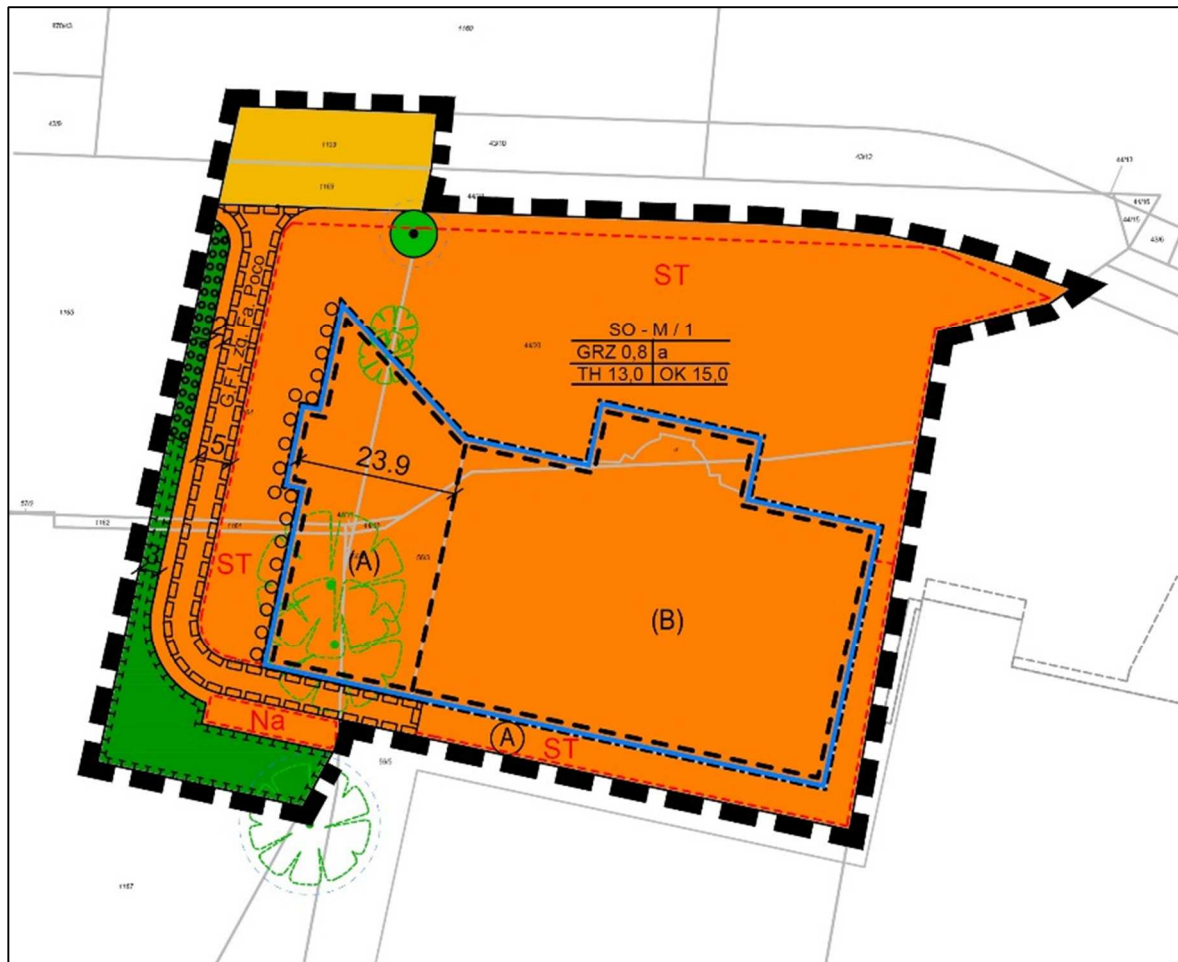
Planungs-Entwurf (dn - Stadtplanung, 04.04.2023)
